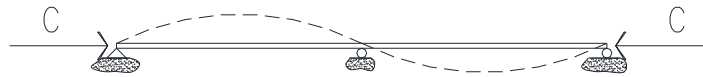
Pandeo del elemento con apoyo fijo al centro.
